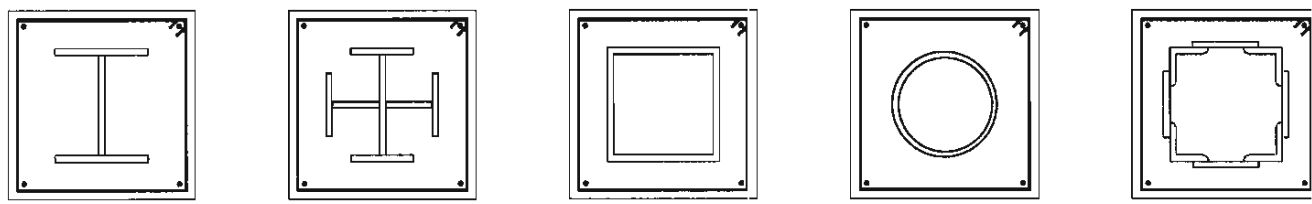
型钢混凝土柱的型钢截面配筋形式
